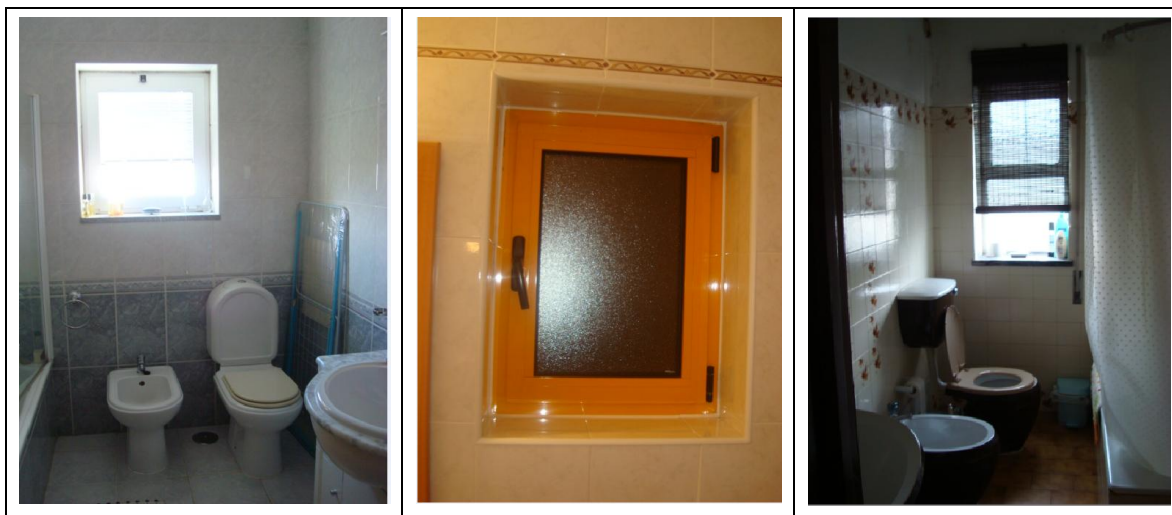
Exemplos de vãos envidraçados em instalações sanitárias
